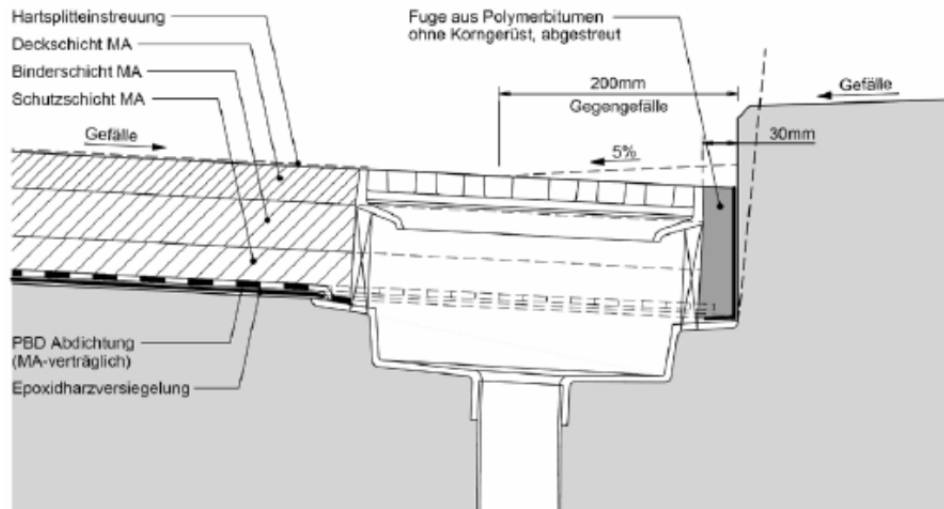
Detail Einlaufschacht (Bild 22 001-12611 aus [10])
